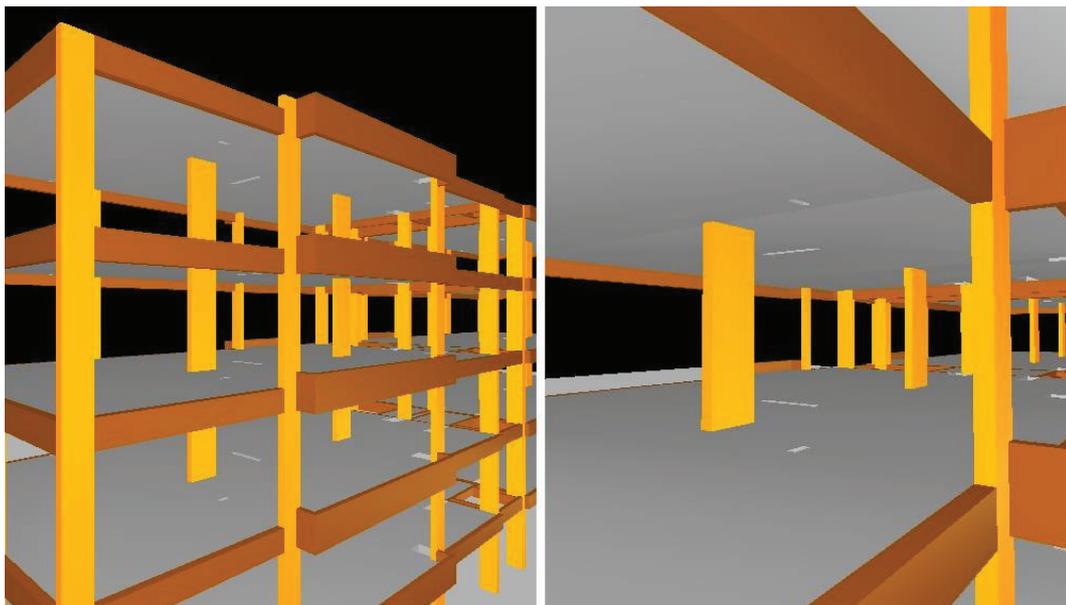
perspectiva dos pavimentos tipo da estrutura em laje lisa
